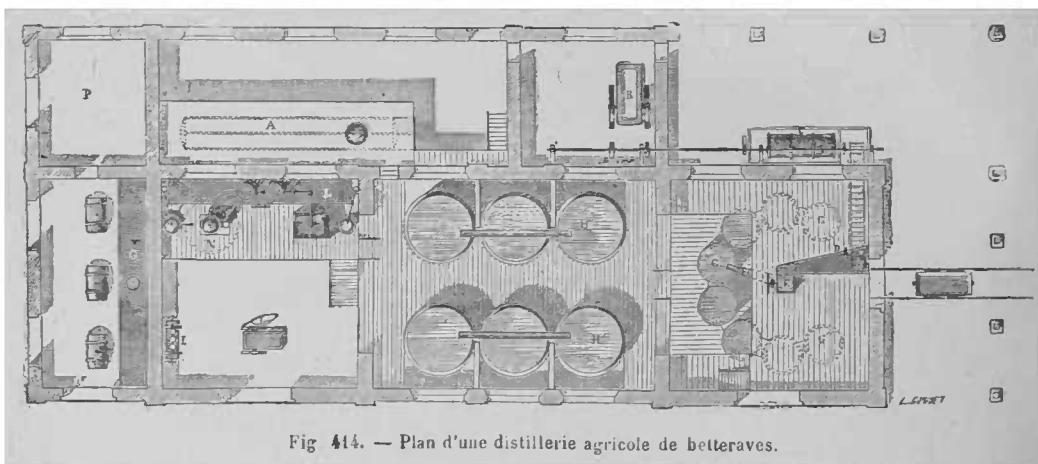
Plan d'une distillerie agricole de betteraves.
